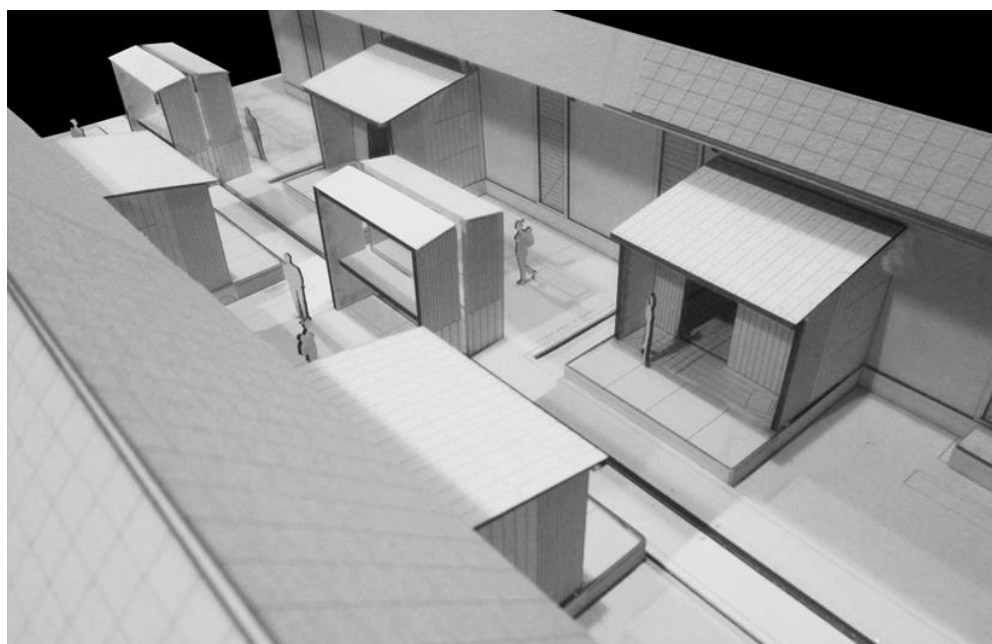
| MODELOS TRIDIMENSIONAIS - ARTICULAÇÃO ENTRE ESPAÇOS
